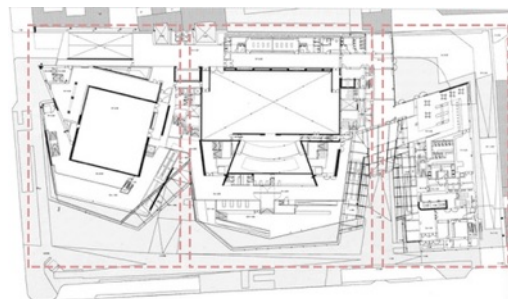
Planta baja y primera generales. División del complejo en tres edificios.
